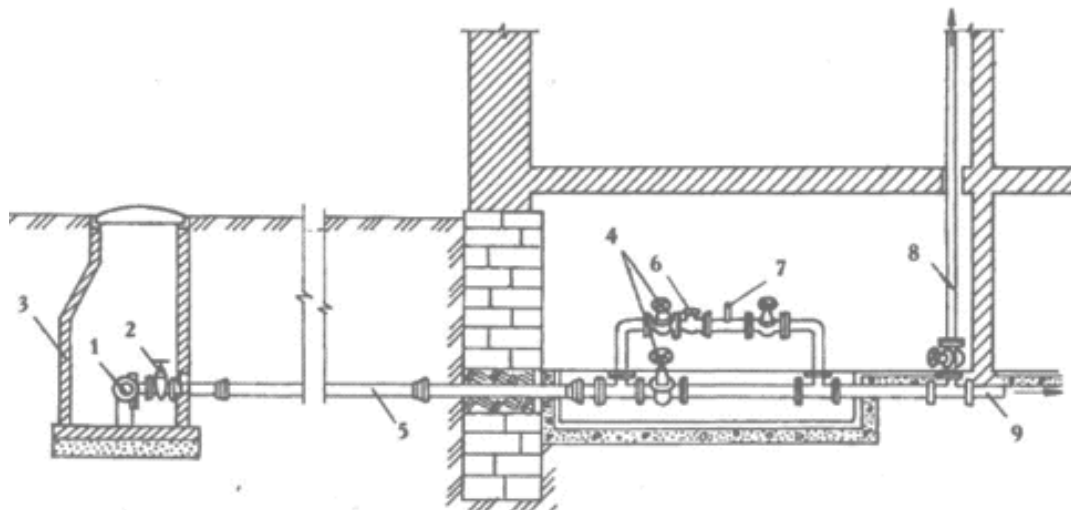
Монтаж водопроводного ввода: 1 - наружный водопровод; 2 - задвижка; 3 - колодец; 4 - вентили; 5 - дворовая сеть; 6 - водомер; 7 - контрольный патрубок со сливом; 8 - стояк; 9 - распределительная сеть.
